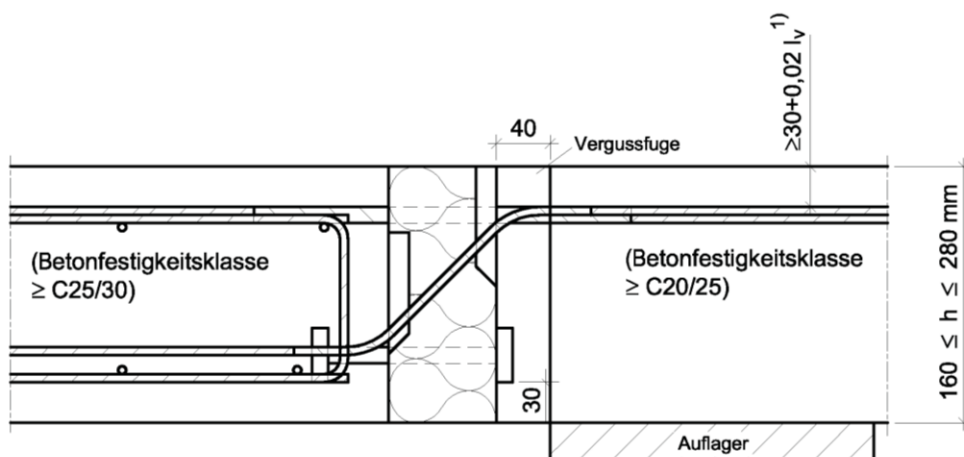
Beispiel Schöck Isokorb Typ RK-239 in eingebautem Zustand mit Vertikalbewehrung nach Abschn. 3.3.1, Z-15.7-239 und Vergussfuge
